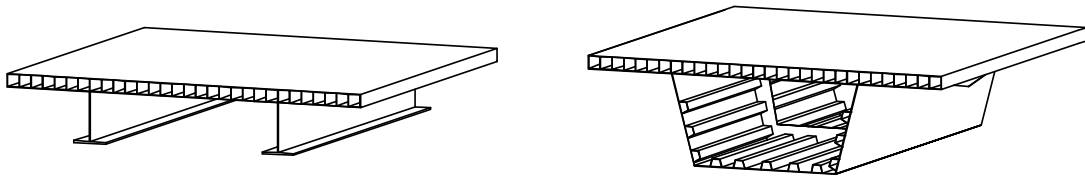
Stahlbrückenkonstruktionen mit Stahlhohlplatten als Fahrbahnelement
